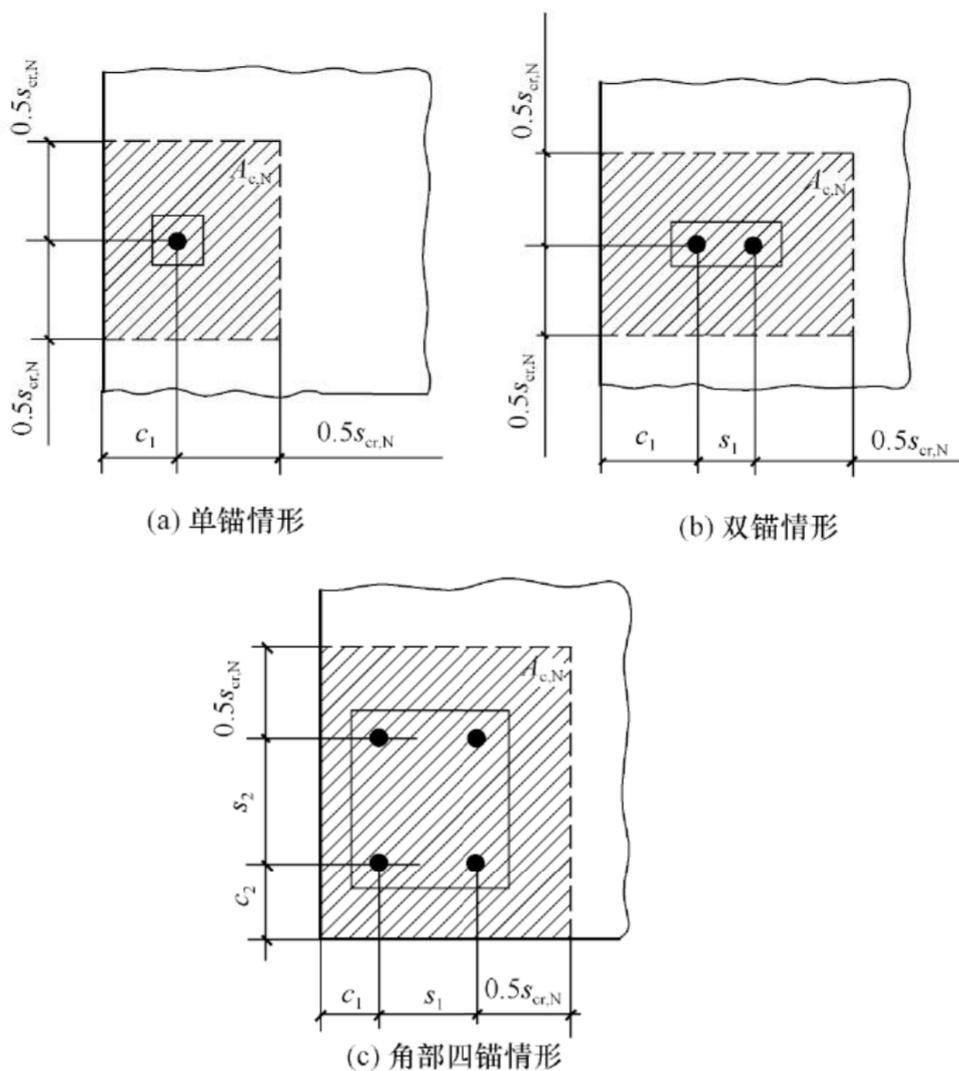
近构件边缘混凝土锥形受拉破坏实际锥体投影面积
